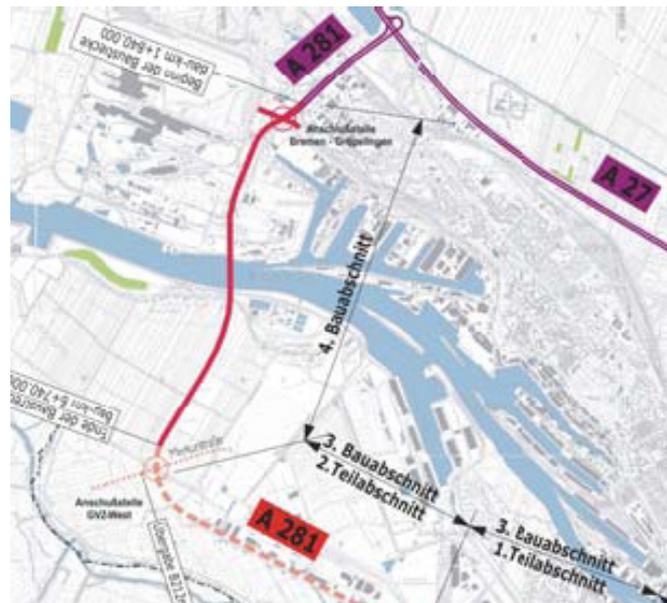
Lageplan des 4. Bauabschnittes der BAB A 281
